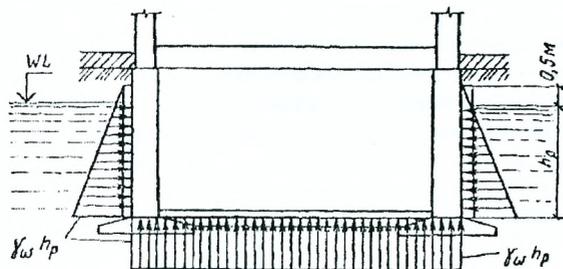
Эпюра гидростатического давления подземных вод на заглубленную конструкцию
